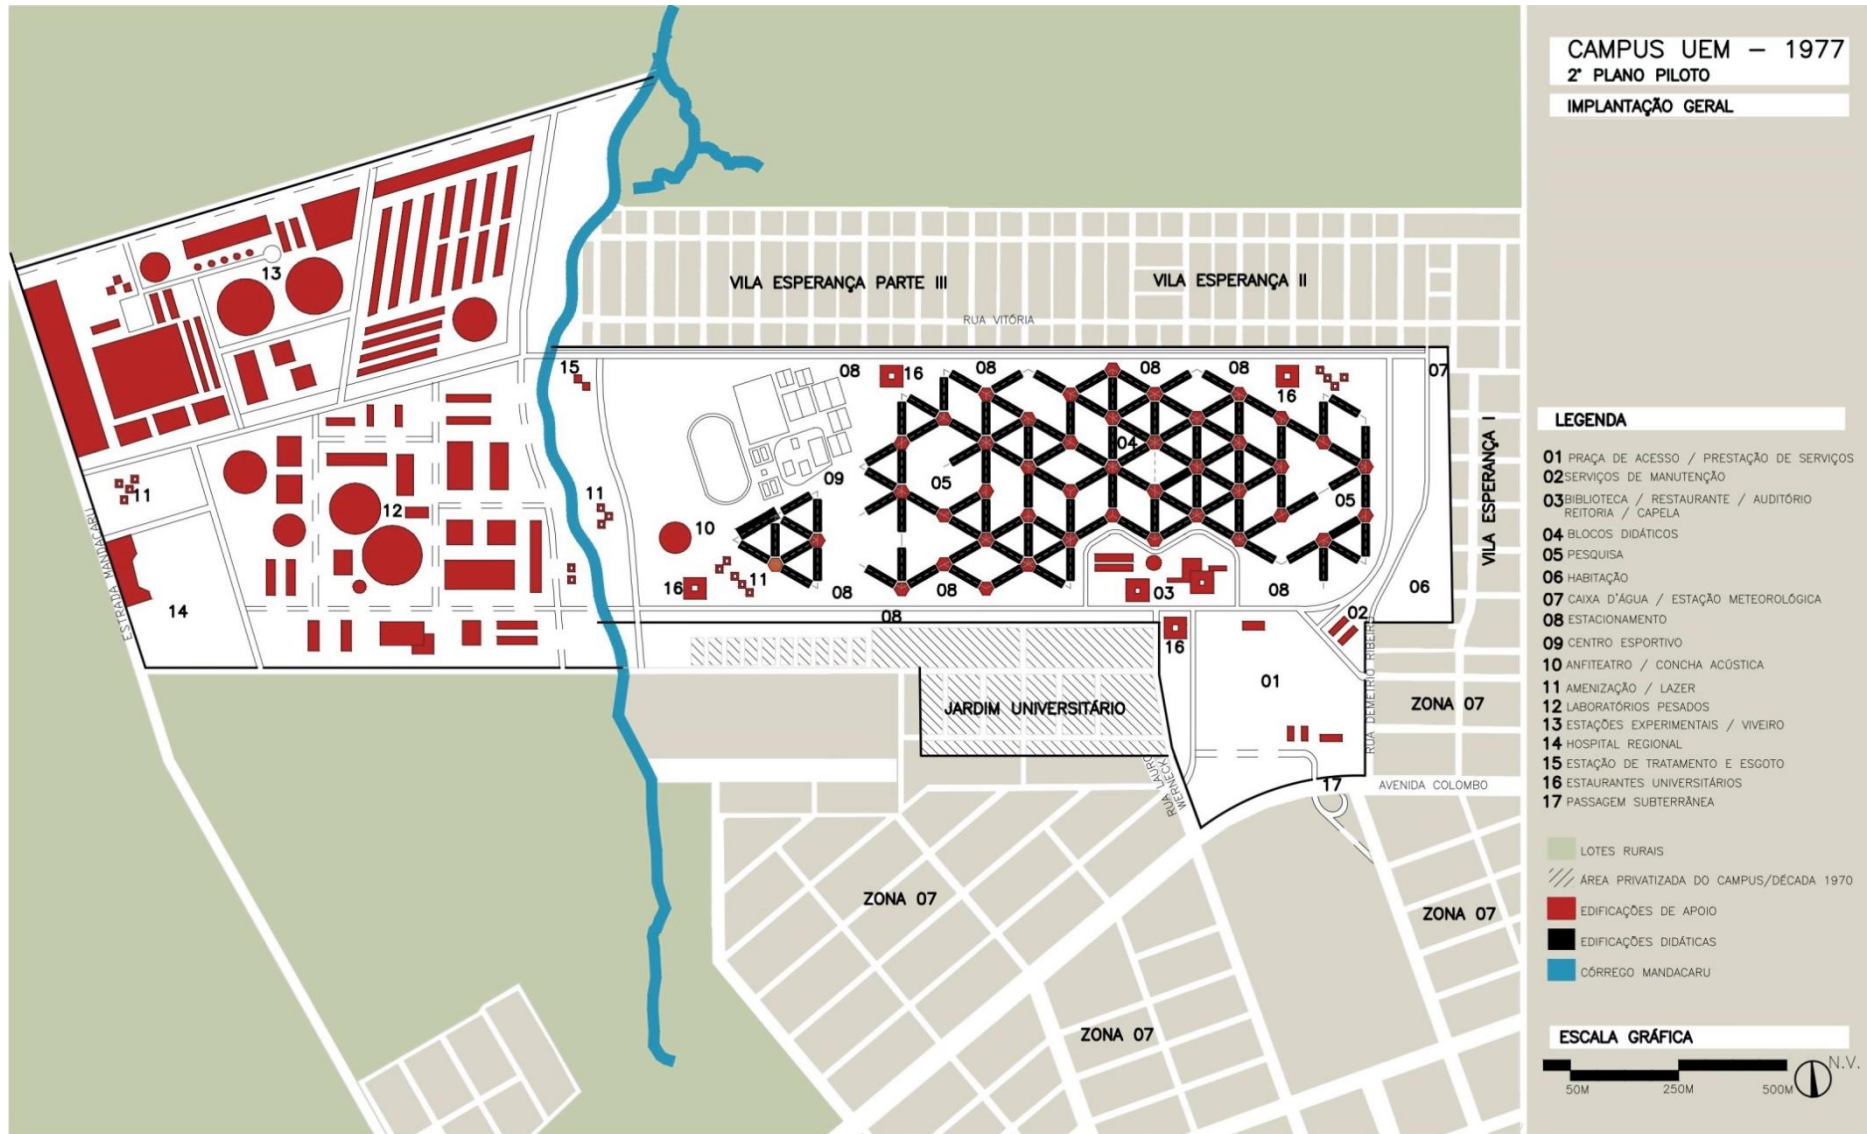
Implantação Geral 2º Plano. Fonte: Mapa Base Prancha 01 – Plano Piloto 1977. Disponível na DOP/PTO. Desenho Renan Avanci.
